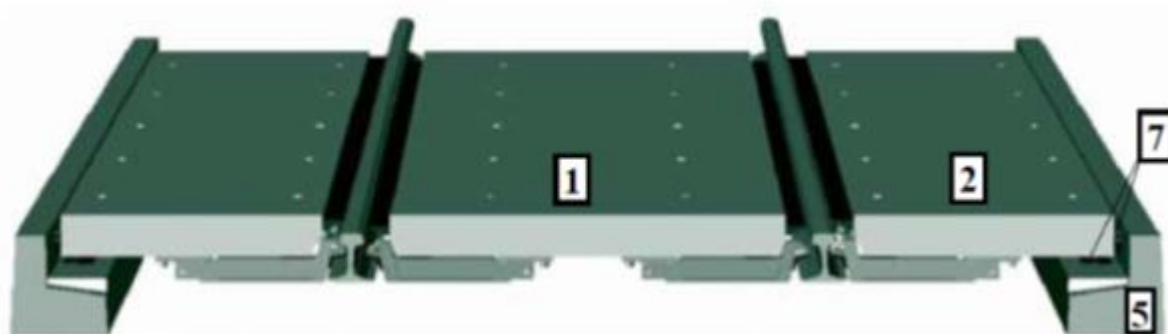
Detail přejezdové konstrukce STRAIL
